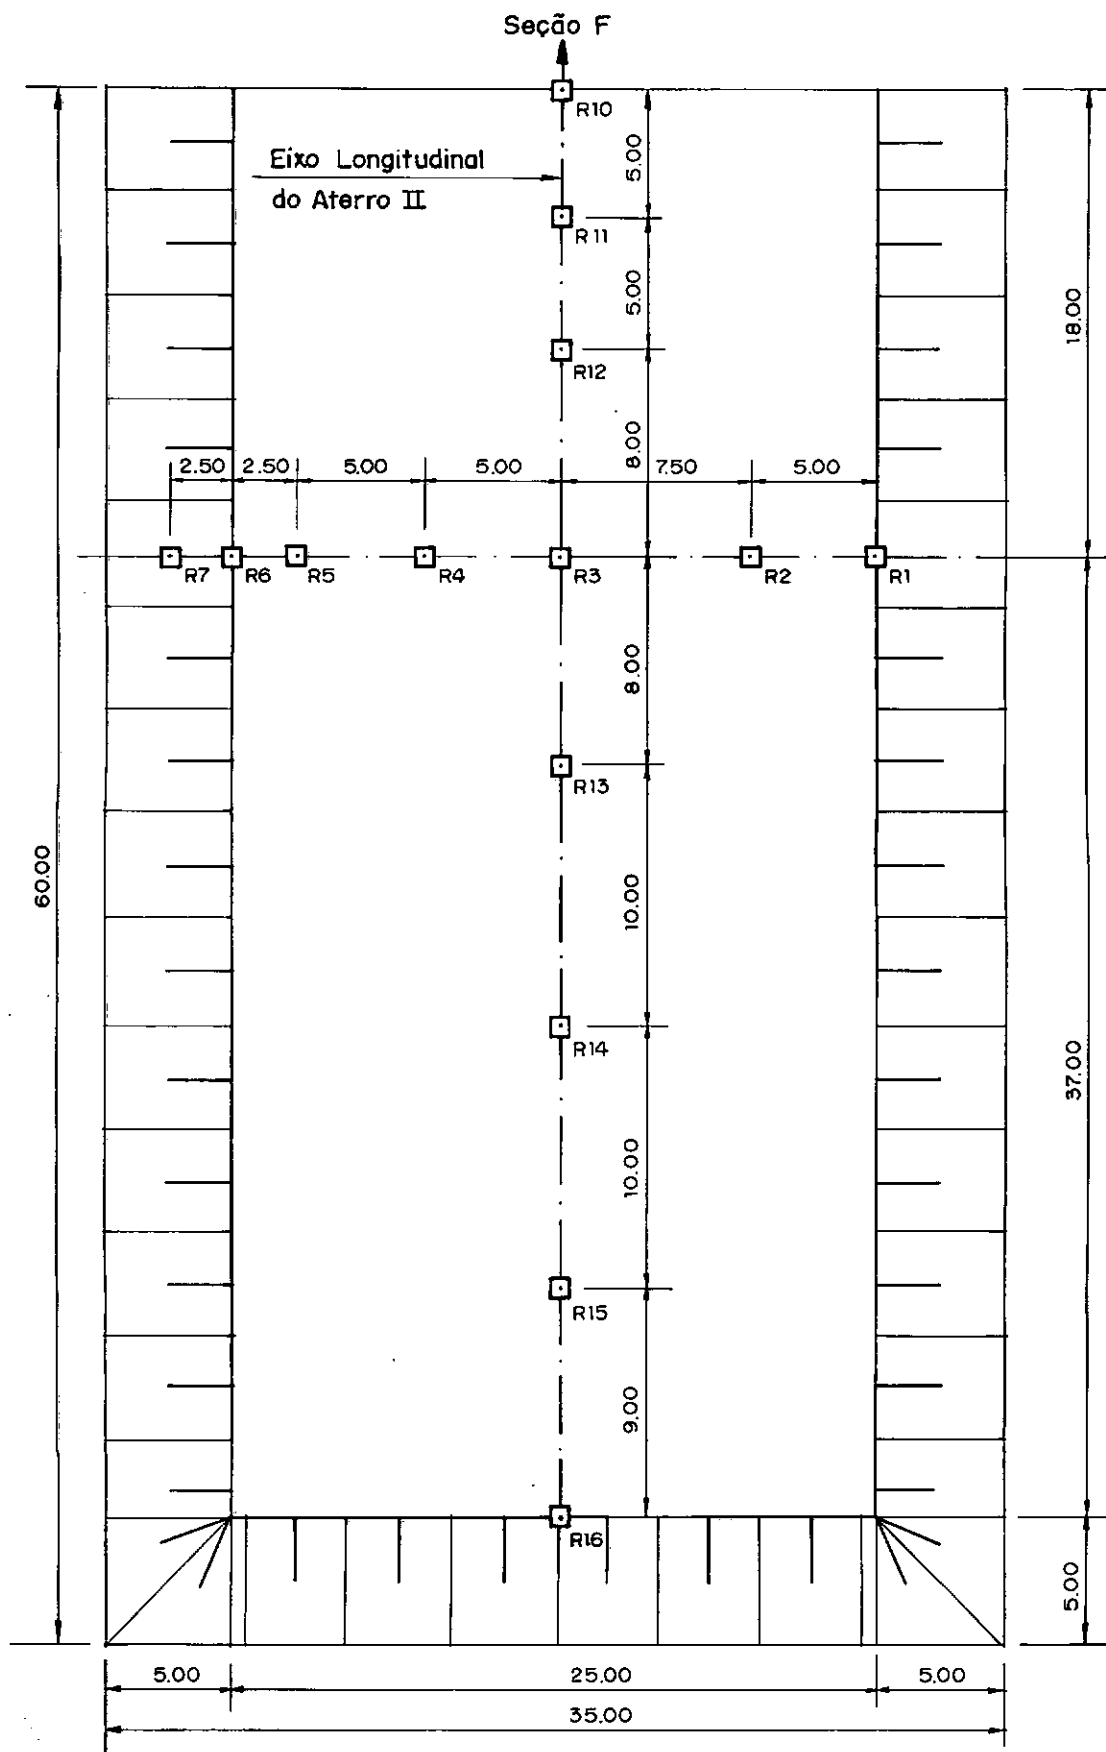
Localização das placas de recalque em planta - Seção G.
